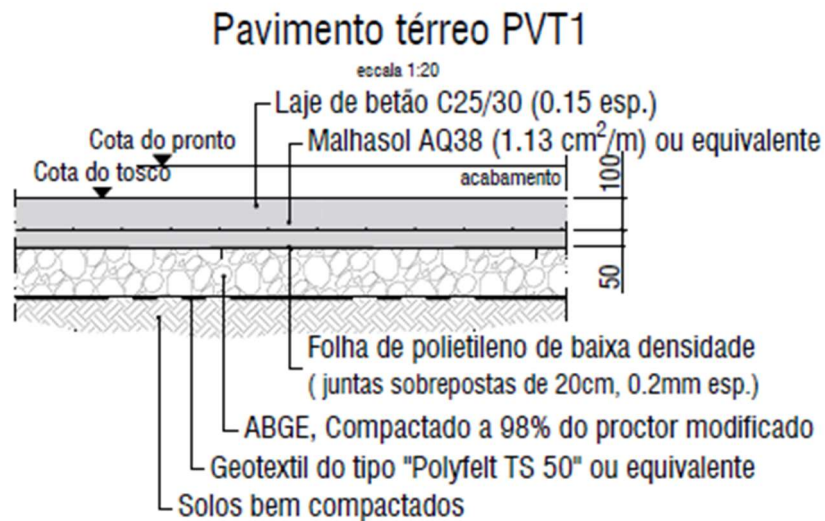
Representação das camadas constituintes do pavimento (Eleven Steps, 2023)
